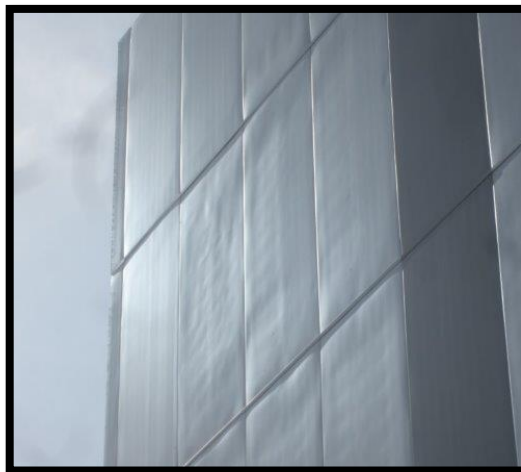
Outra perspectiva da identificação de patologias no painel exterior de fachada
